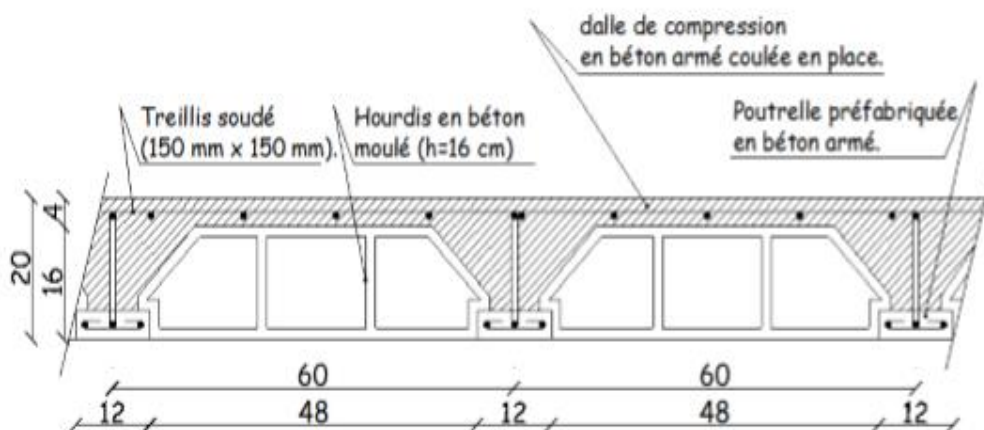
Schéma descriptif d'un plancher en corps creux
